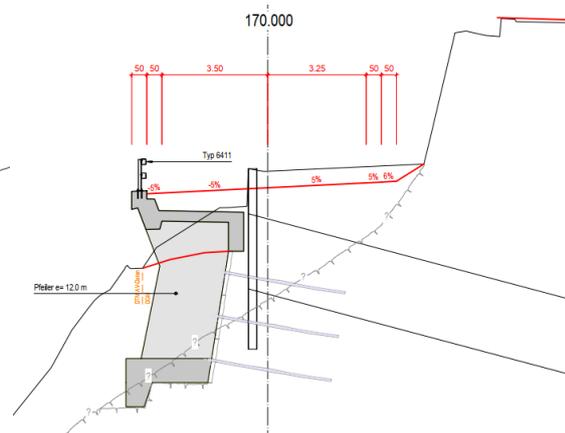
Querprofil m 170 (Lehnenbauwerk)
